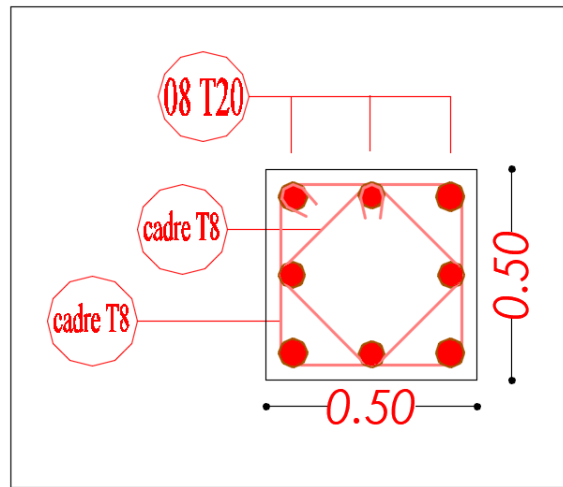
shéma ferrailage poteau(50× 50)cm²
